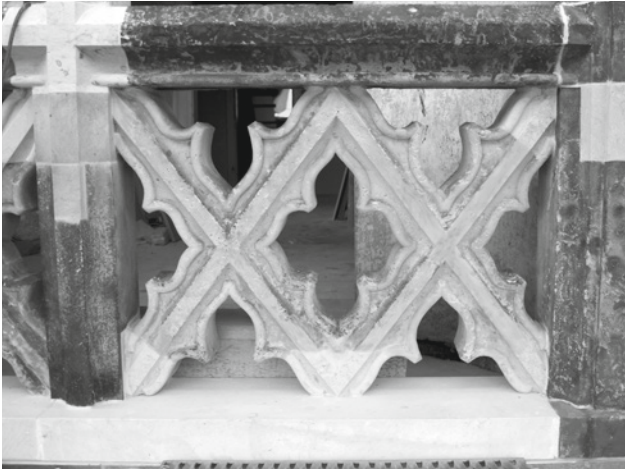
Detailansicht der Brüstung des Balkons mit eingesetzten Vierungen
